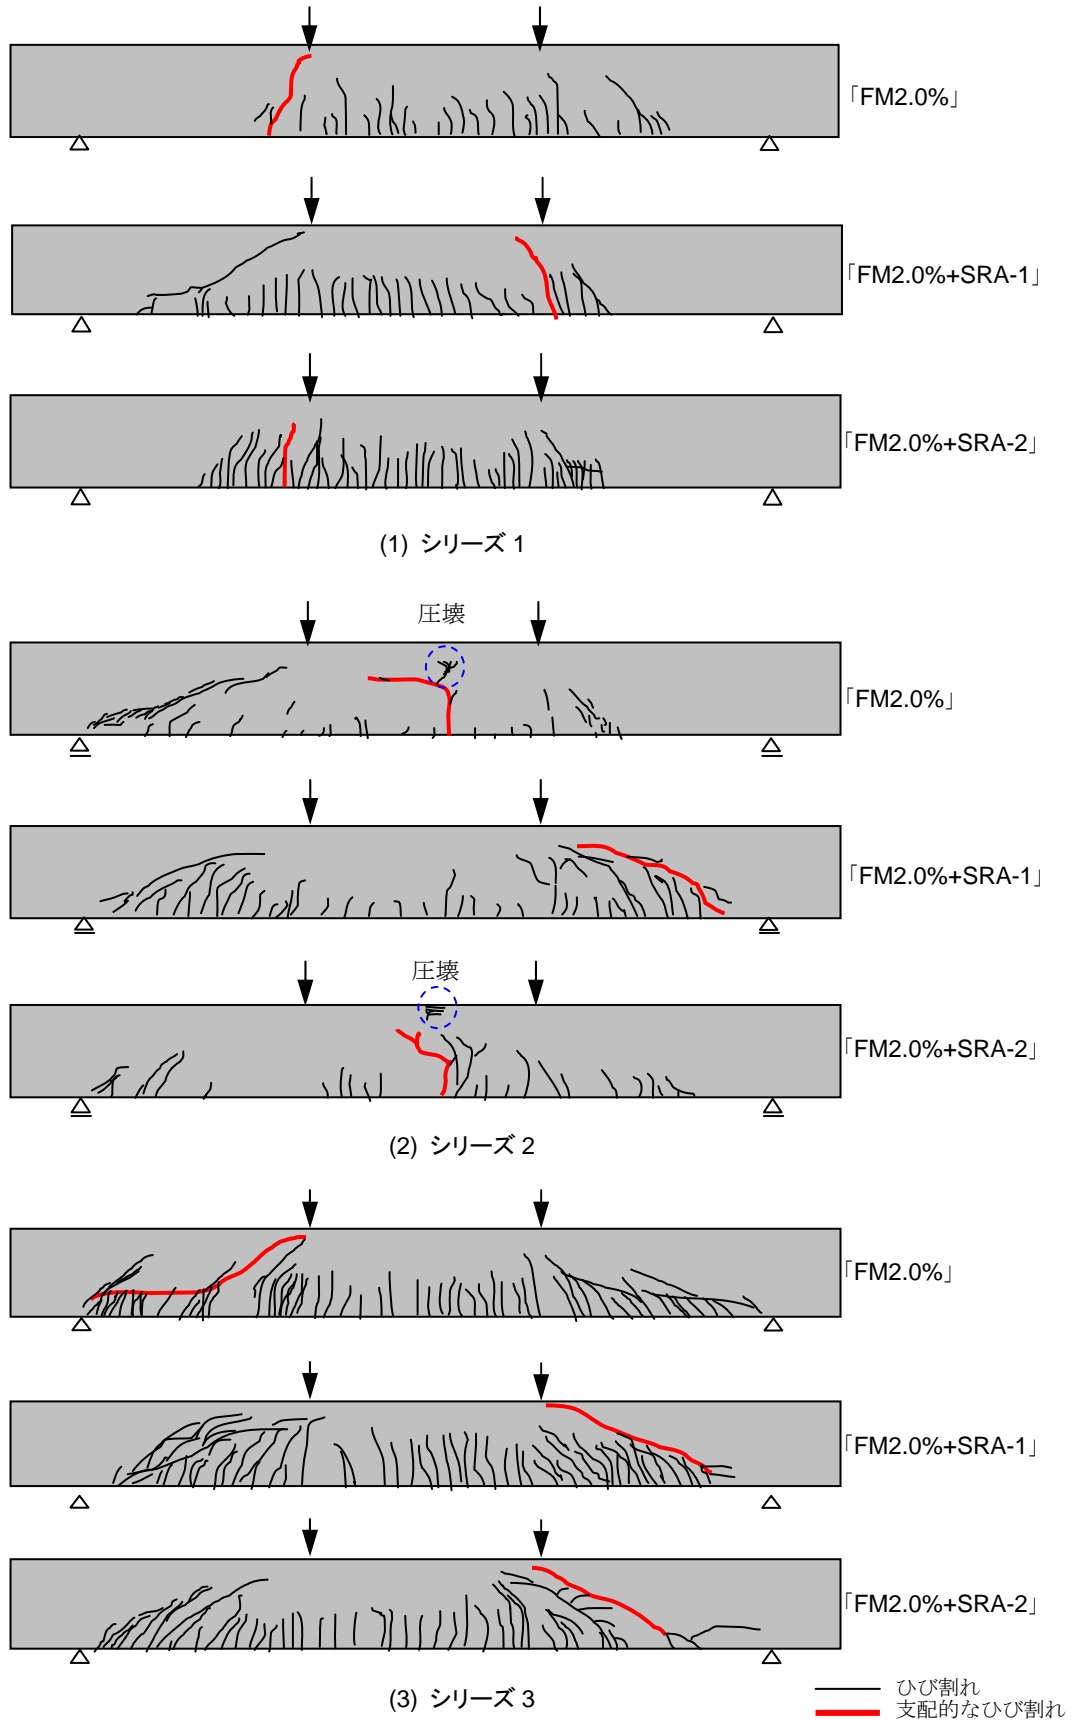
ひび割れ性状(複合 RC はり部材)
